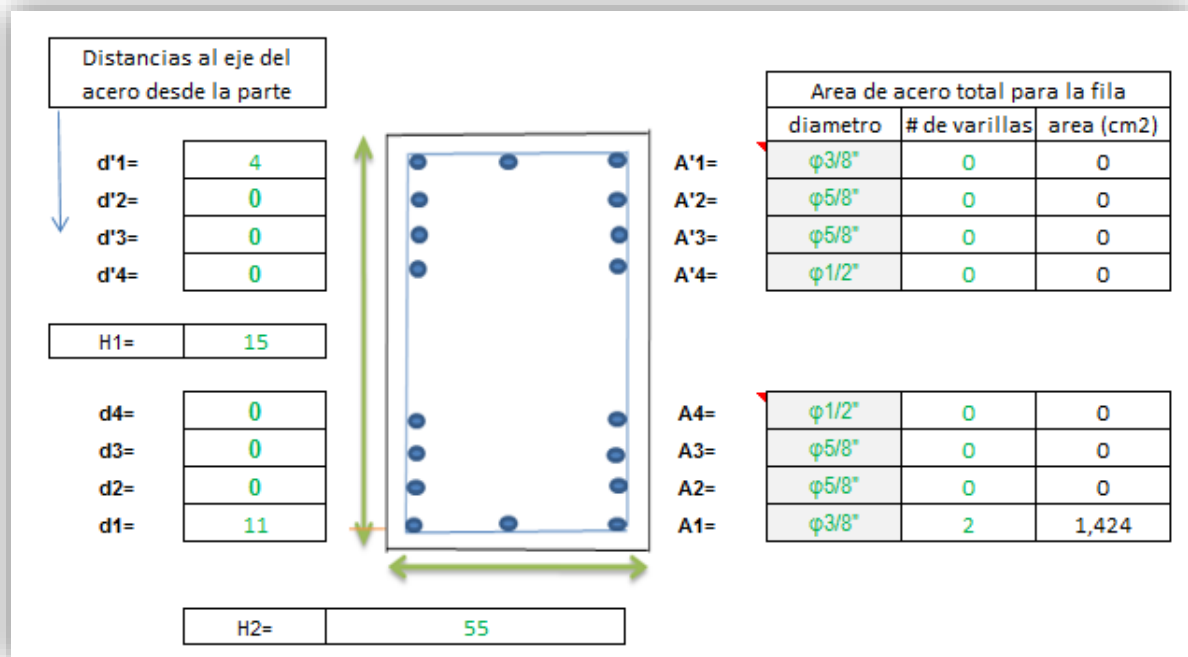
Acero de refuerzo en la escalera 2
